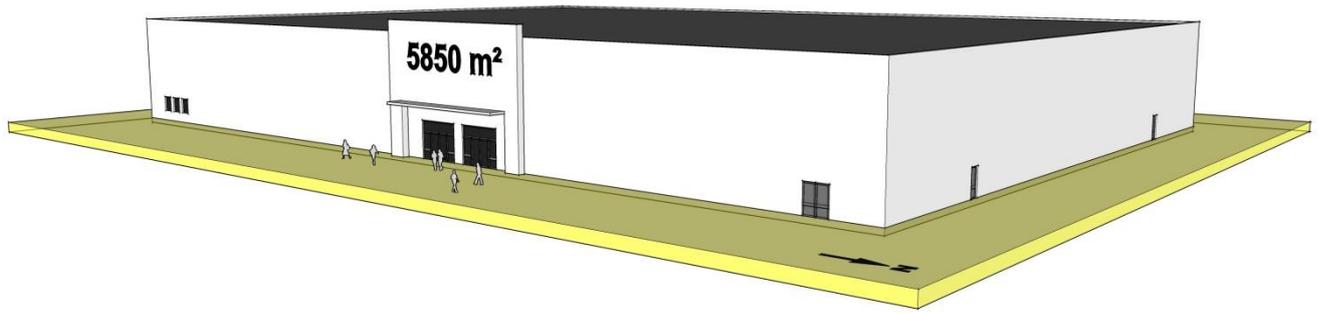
Verbrauchermärkte – Baumarkt – Darstellung Gebäude – Ansicht Nord-Ost
